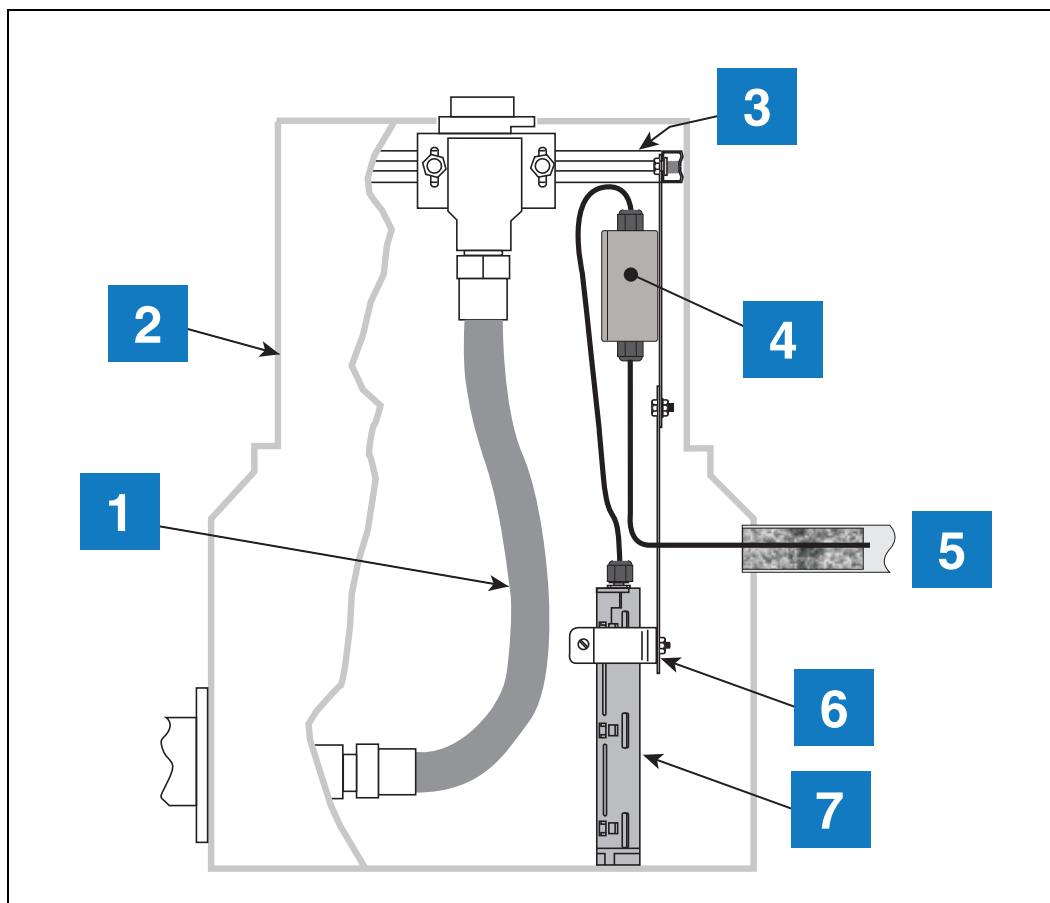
Esempio di installazione sensore in pozzetto di contenimento
